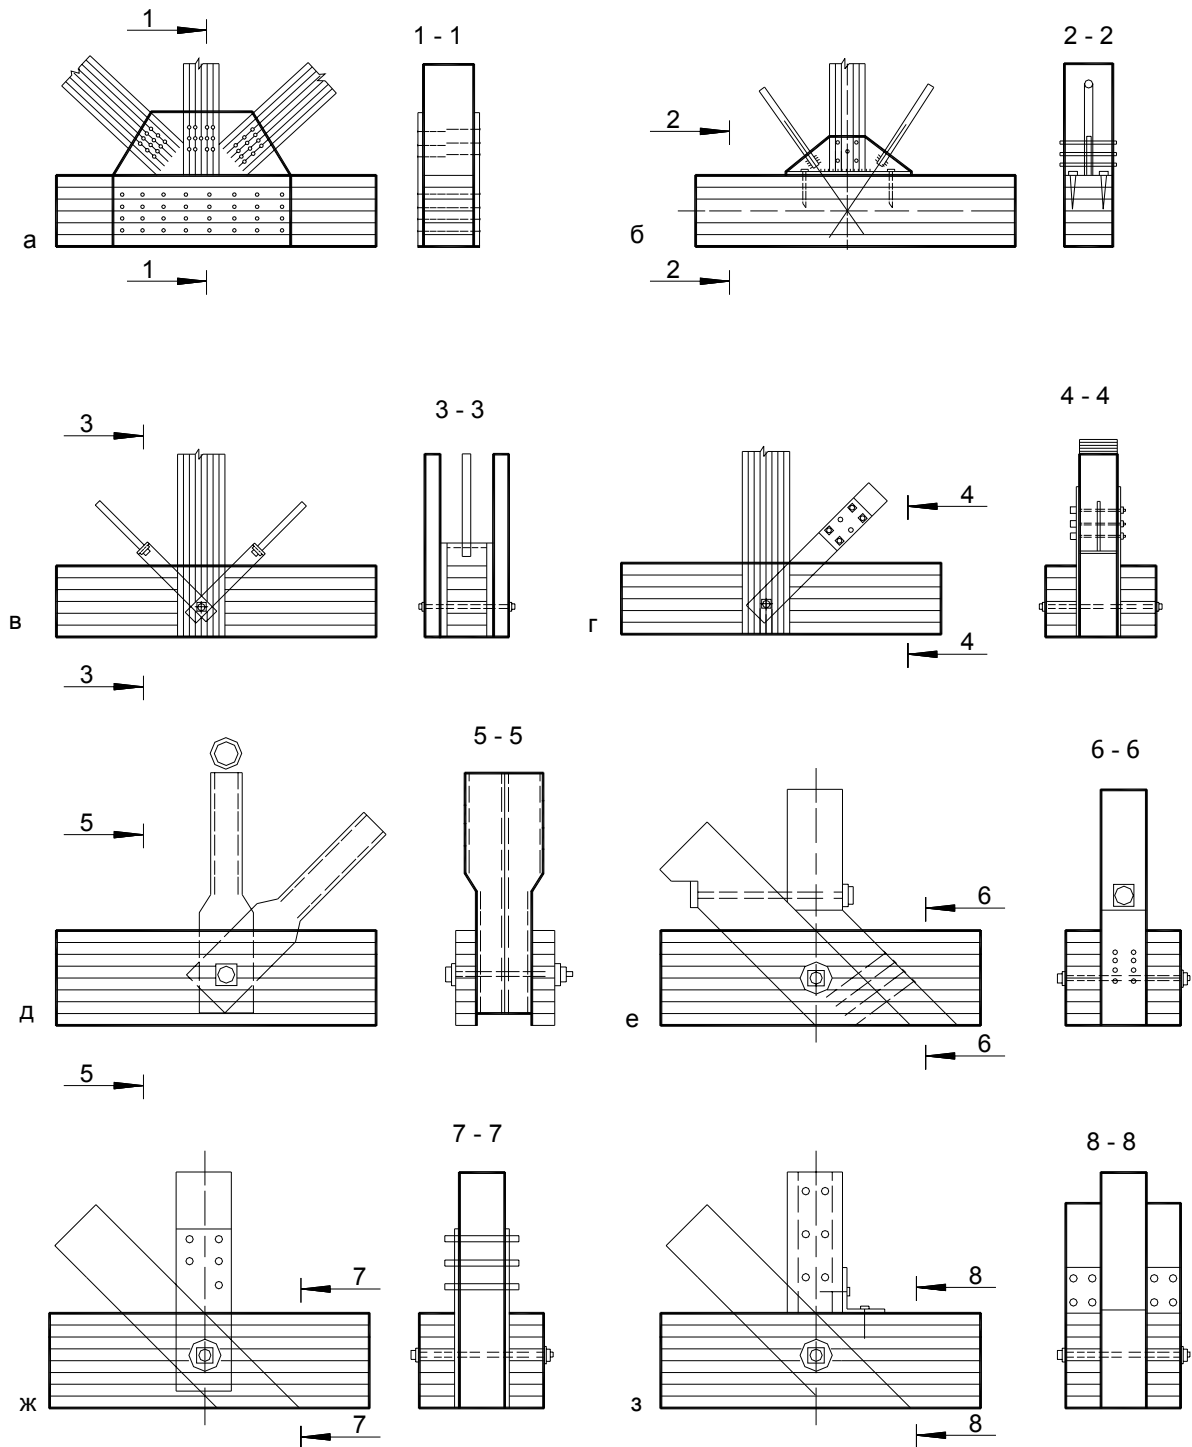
Конструкции нижних промежуточных узлов ферм:
